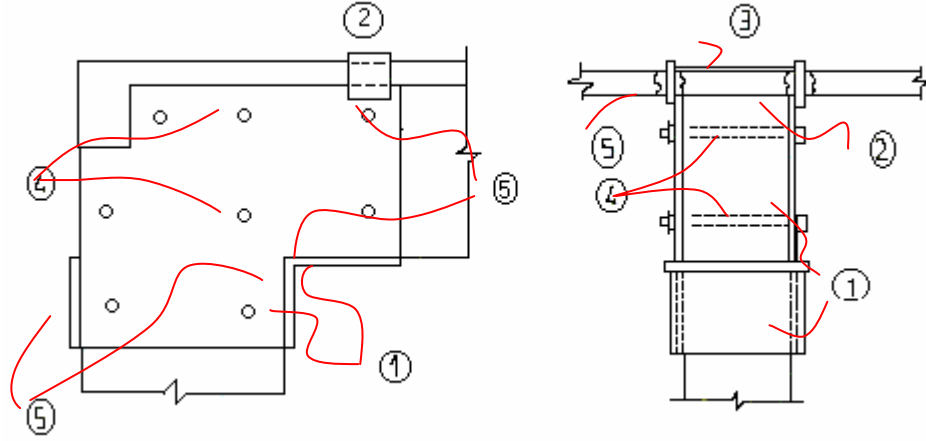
Betonarme Manto Ayrıntıları [4]
